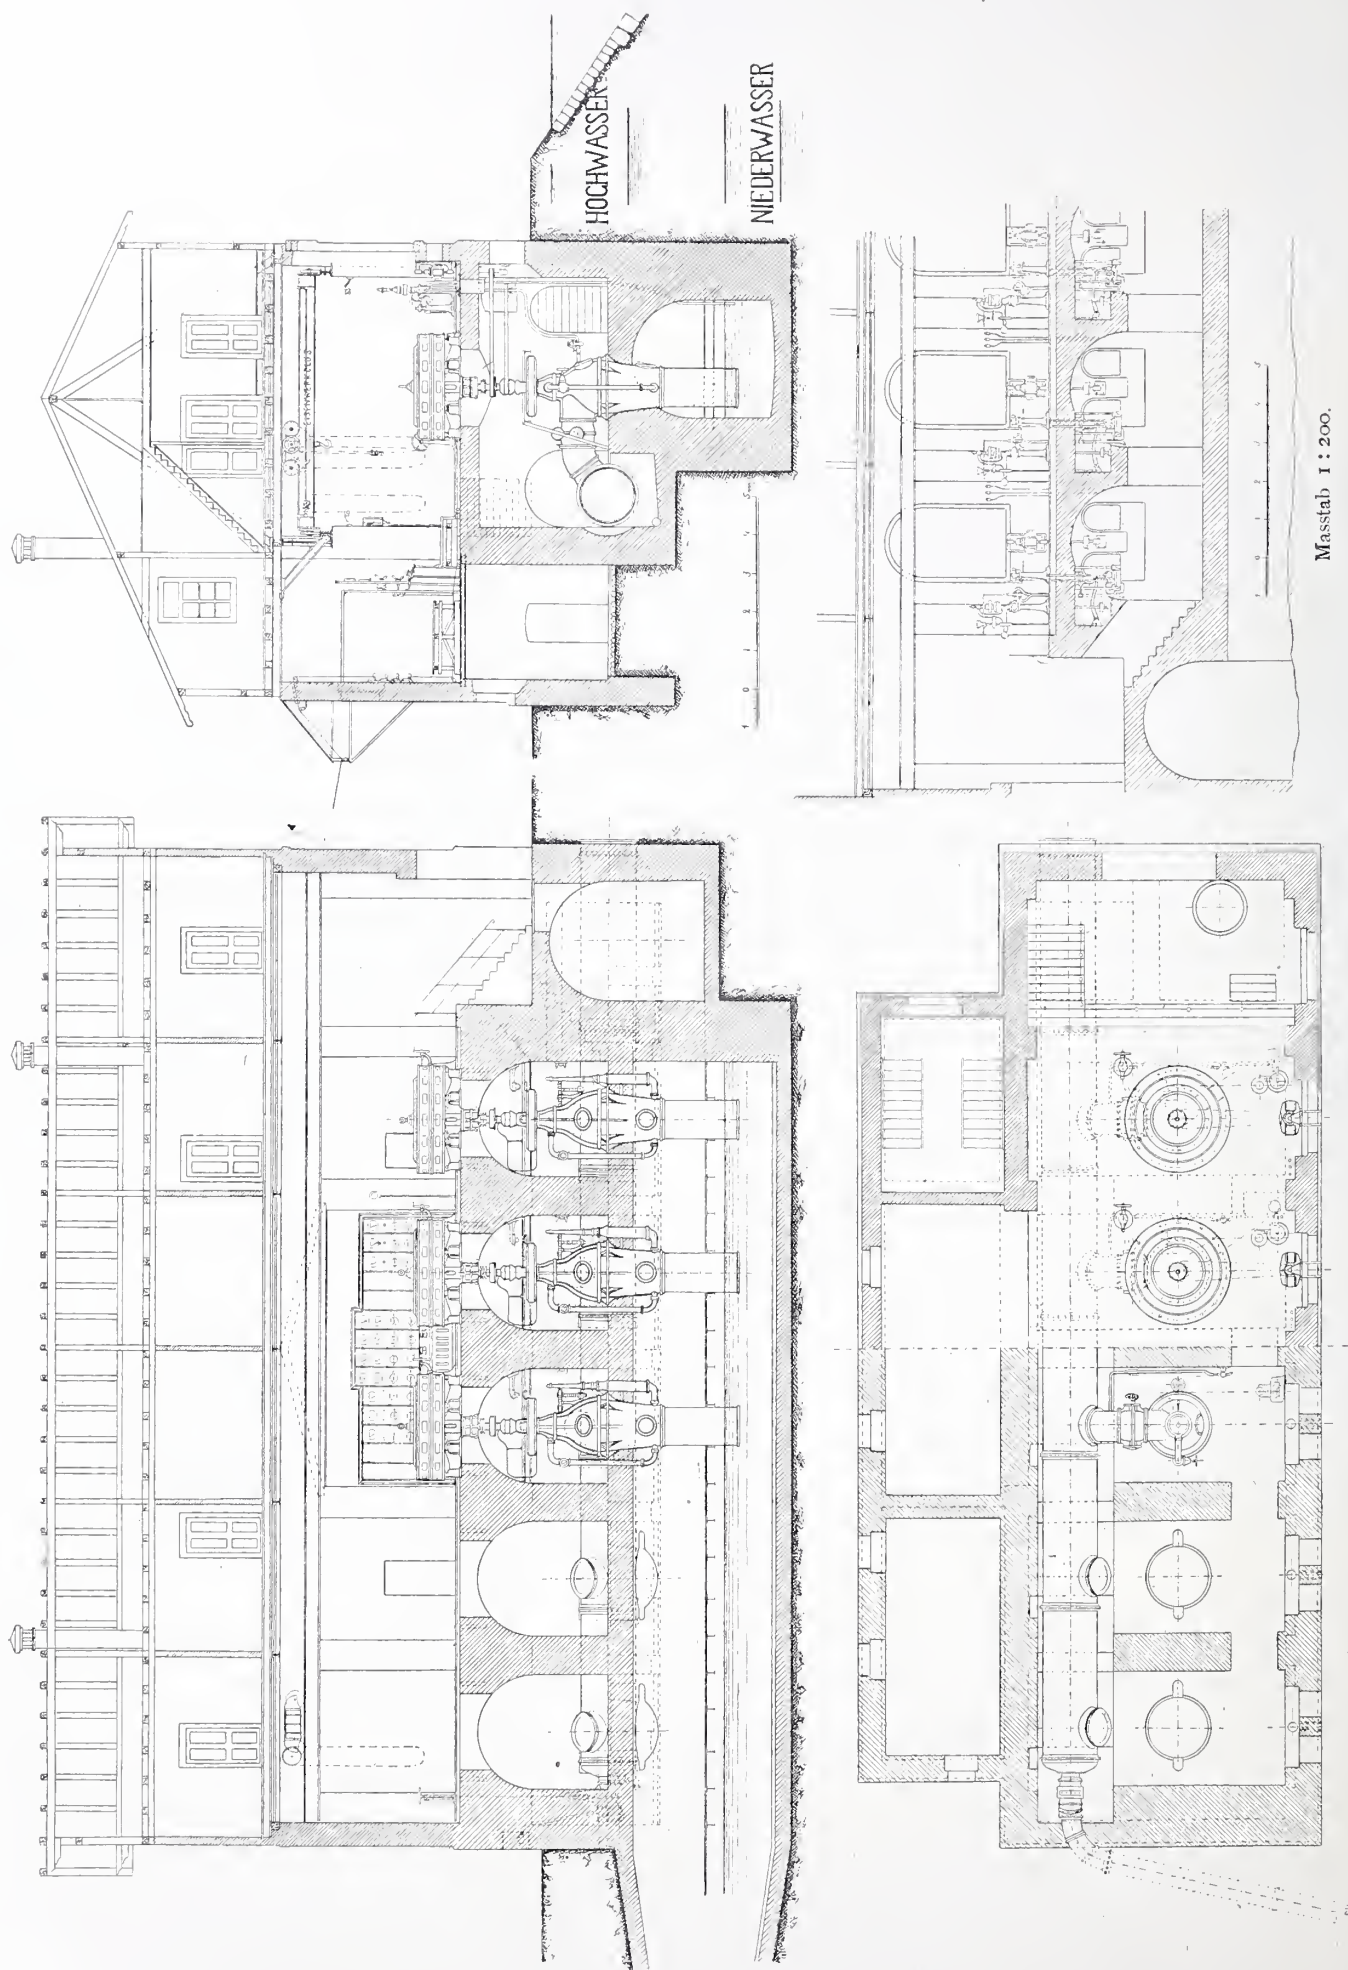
35. Schmitte und Grundriss des Maschinenhauses.
